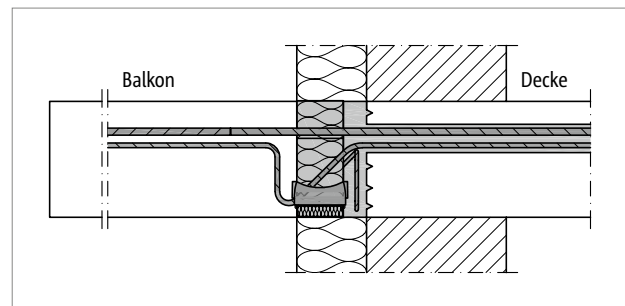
Schöck Isokorb® RT Typ K, Schöck Isokorb® T Typ K: Balkon frei ausragend mit direkter Lagerung bei Erweiterung eines Bestandsbalkons
